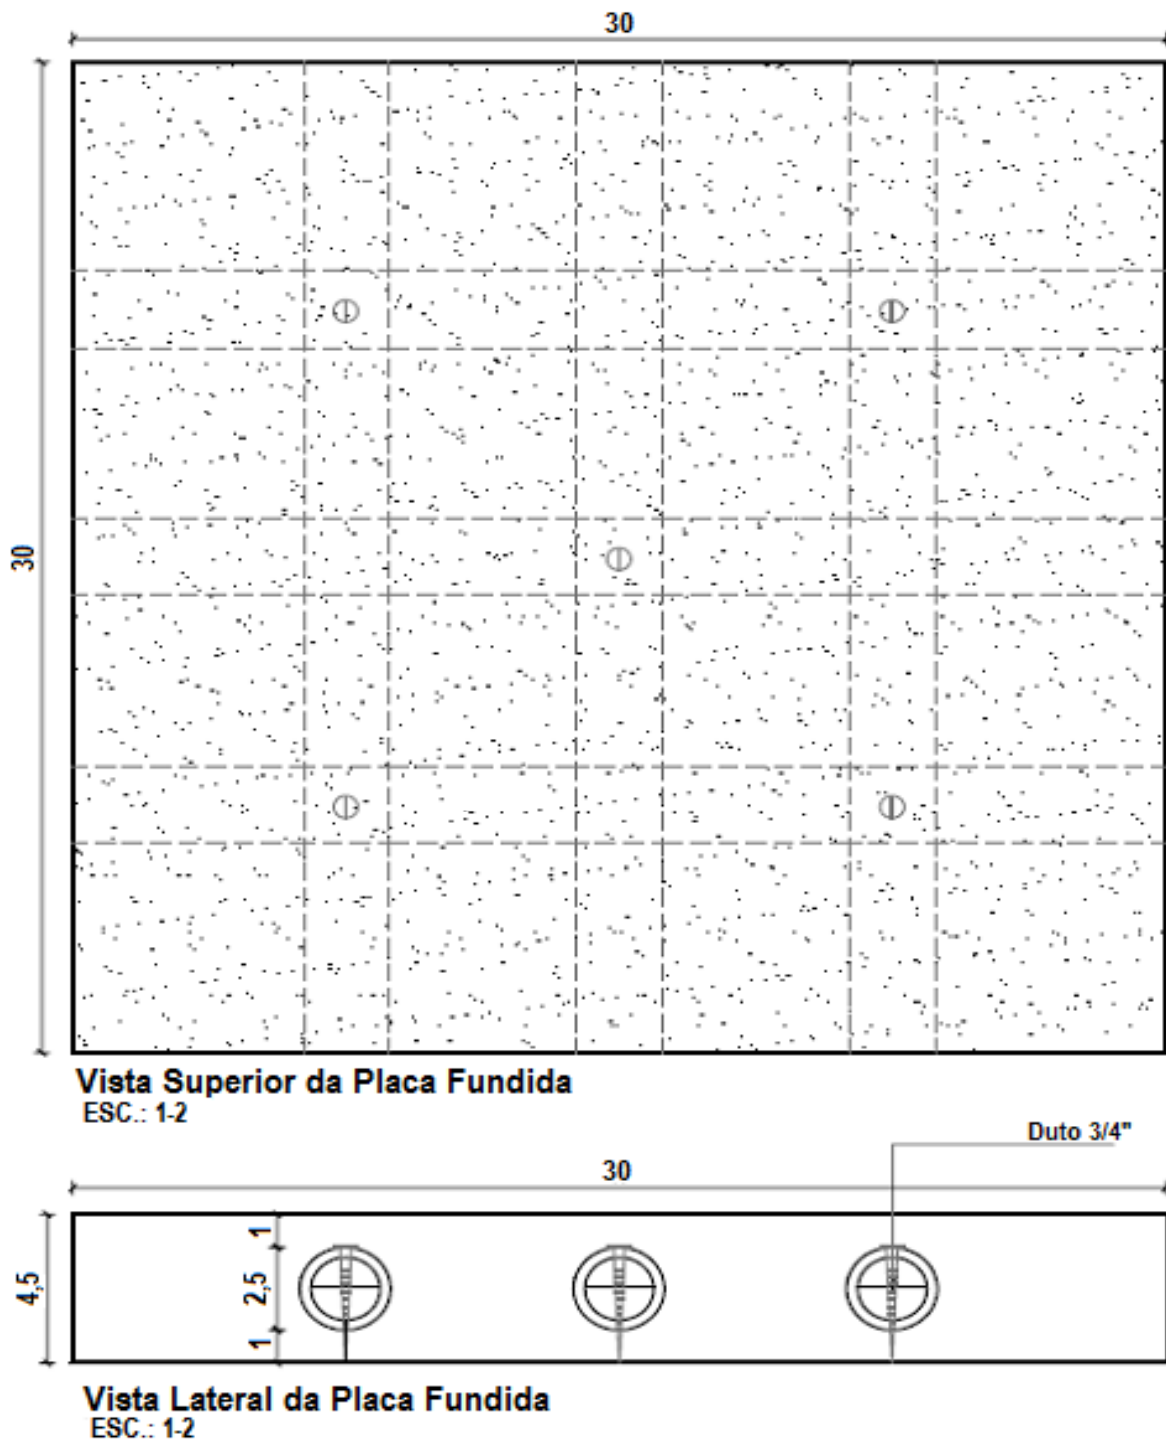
Planta e vista da placa fundida, comprimento de 30 cm e altura de 4,5 cm.
